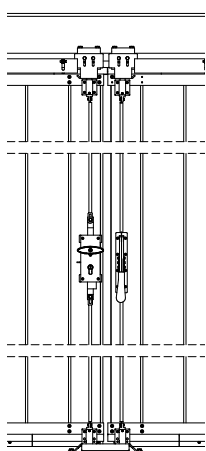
Блокировка двупольных ворот (DW) – вид с внутренней стороны.
